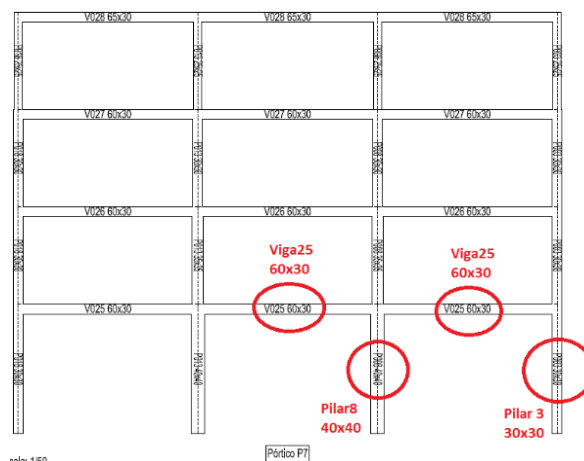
Vigas que acometen en cabeza de pilar 8 y 3. Pórtico incluido en el plano 4 del Anexo I.
